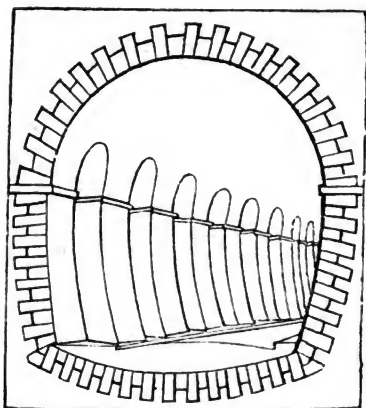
Coupe transversale du côté ouest du tunnel de la Tamise à Londres.
